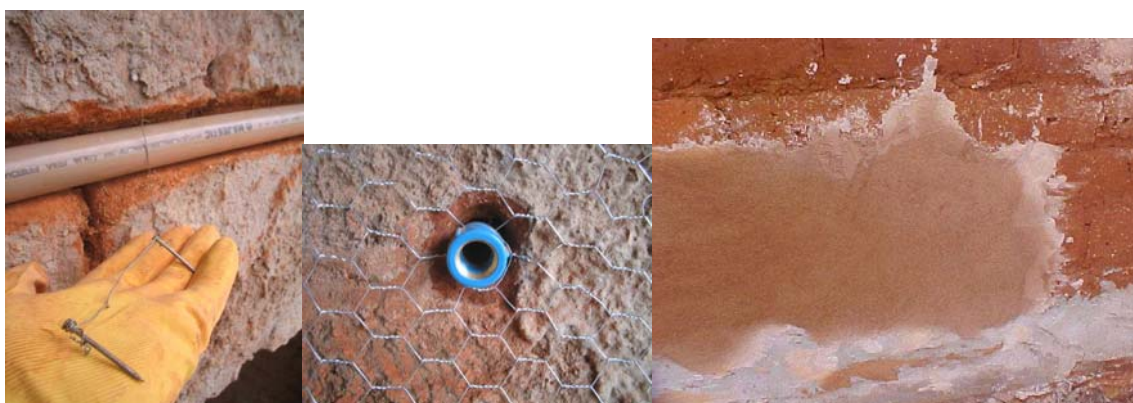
RASGO DE PAREDE DE ADOBE PARA INSTALAÇÃO DE CANO / COLOCAÇÃO DE MALHA DE AÇO PARA REDUZIR PROBLEMA COM REVESTIMENTO EXECUTADO COM ARGAMASSA DE CIMENTO / TESTE DE REVESTIMENTO EM PAREDE DE ADOBE UTILIZANDO ARGAMASSA DE SOLO E CAL (FONTE: GRUPO DE PESQUISA HABIS, 2004 E 2005)
